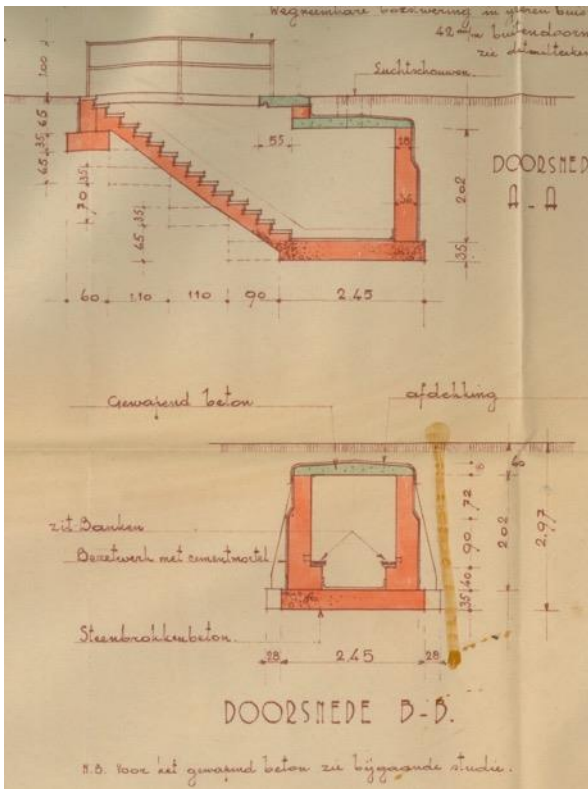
Grondplan van de te bouwen schuilkelders uit 1939 (© stadsarchief Vilvoorde).
